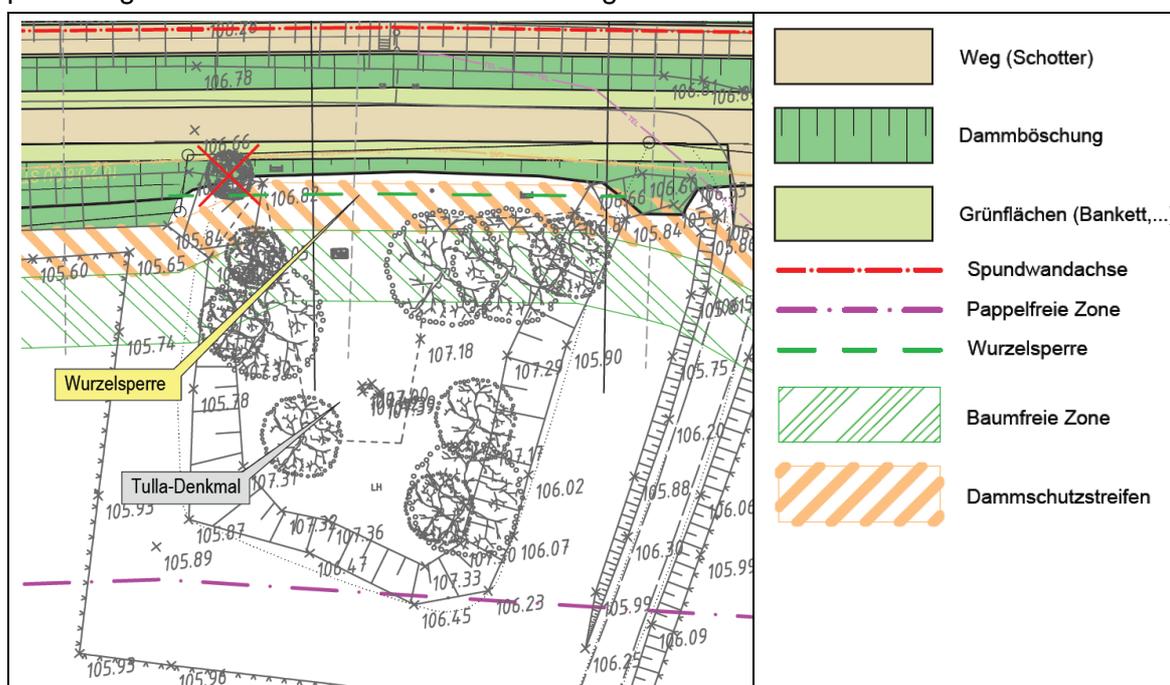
Planung im Bereich Tulla-Denkmal, die wegfallende kleinere Ahorngruppe ist mit einem roten X gekennzeichnet (Quelle: Auszug aus Anlage 2.2.7 zum Planfeststellungsantrag, Lageplan Nr. 3, Auszug ist nicht genordet)
